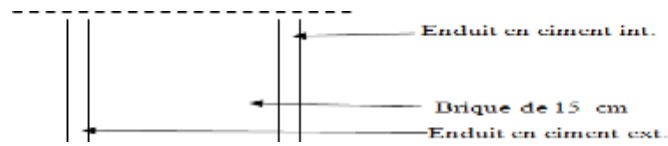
Coupe transversale des murs intérieurs (type 2)
